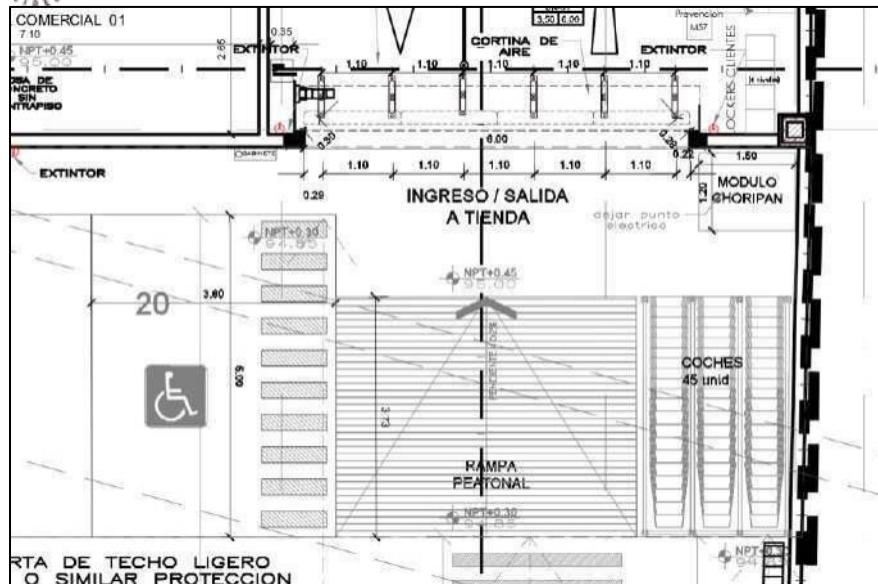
Plano Arquitectura– Ingreso a la Sala de Ventas.
